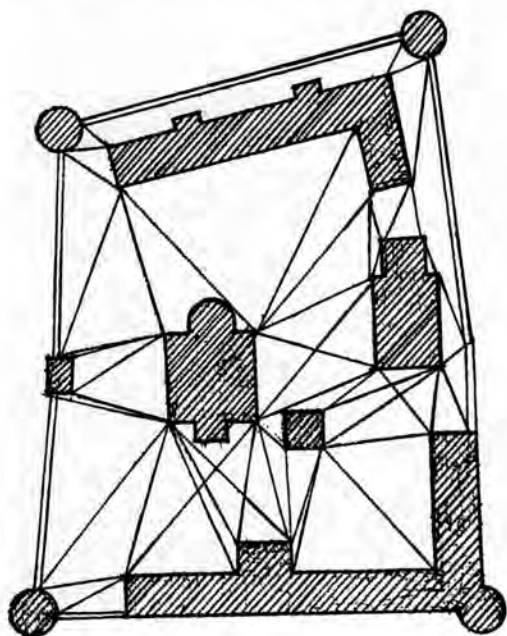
Обмеры генерального плана комплекса зданий засечками
